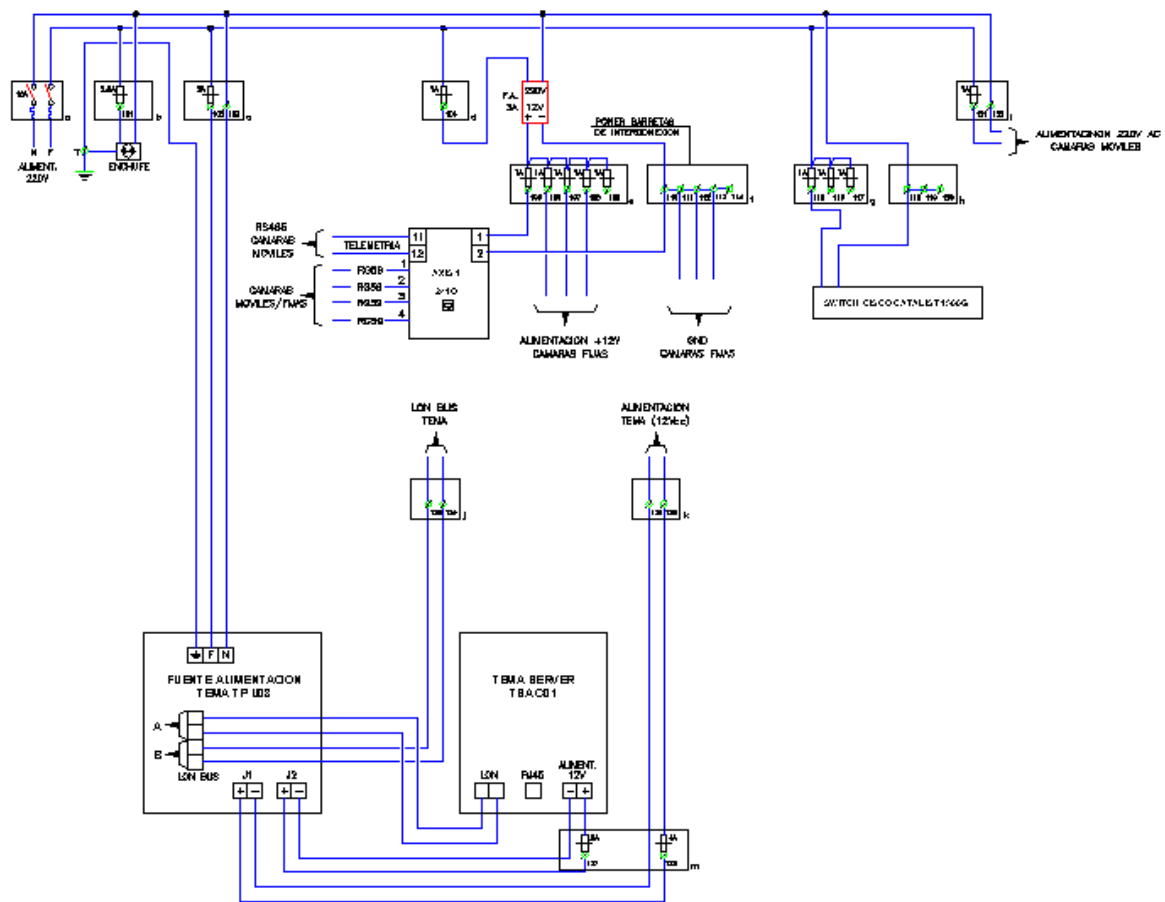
Cableado cuadro eléctrico de la zona este sur planta baja
